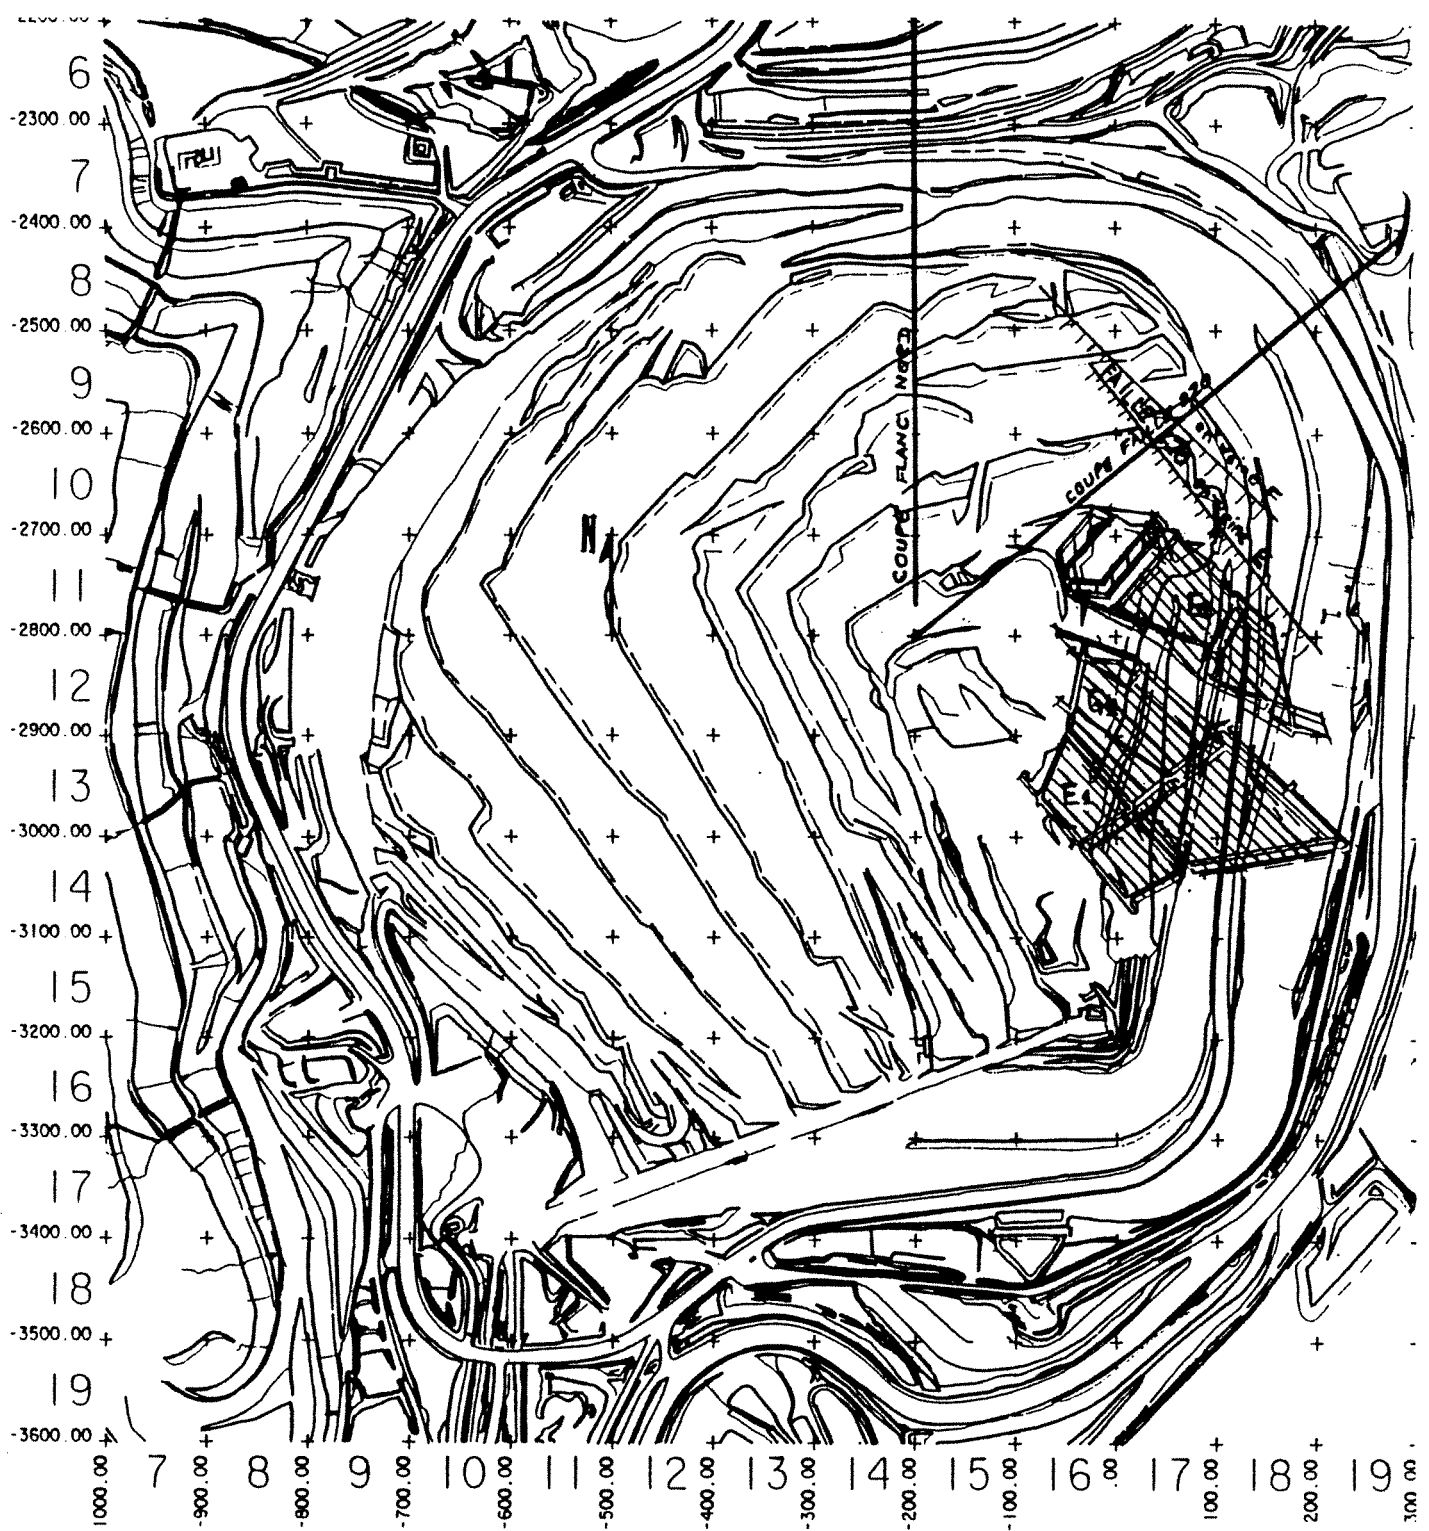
Plan de la découverte : situation des panneaux d'anciens travaux auscultés au flanc est
